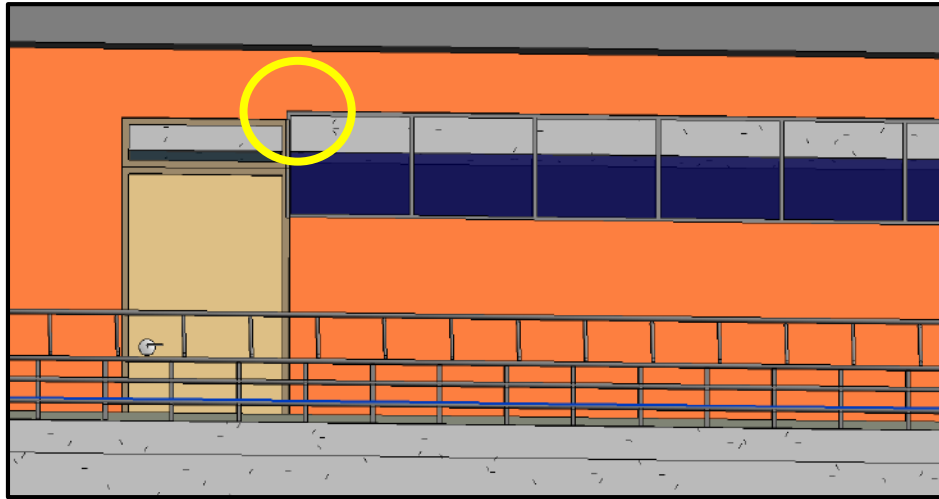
B: Plano AutoCAD (Expediente Técnico) y modelado en Revit: Incompatibilidad de viga y puerta
